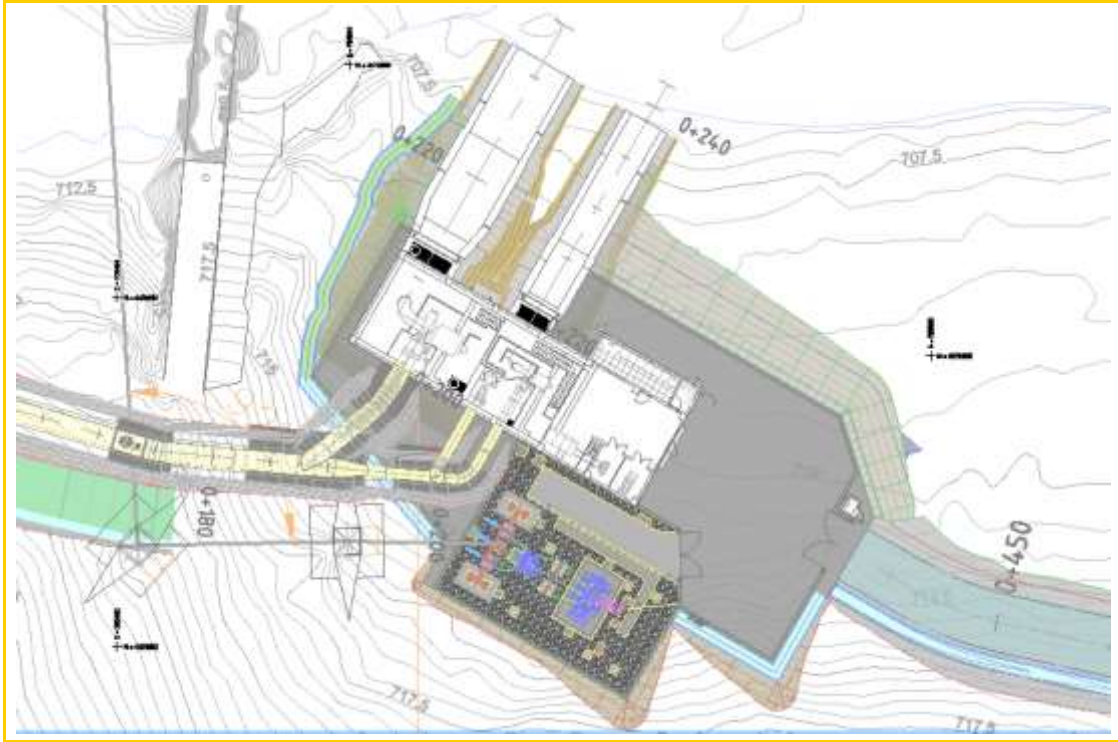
Planta de la Casa de Máquinas de Irueña.
